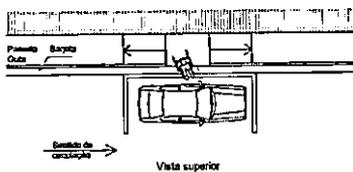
Vagas para estacionamento junto a passeio rebaixado
